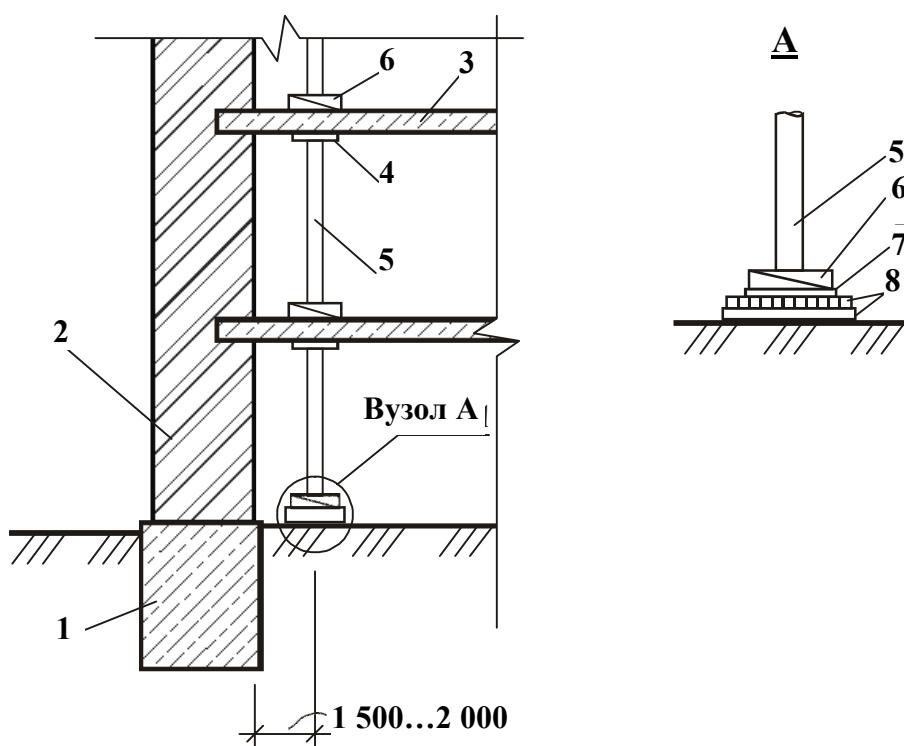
Часткове розвантаження фундаменту із застосуванням тимчасових дерев'яних опор: 1 – фундамент; 2 – стіна; 3 – перекриття; 4 – верхній прогін; 5 – стояк; 6 – клини; 7 – опорний брус; 8 – опорна подушка
